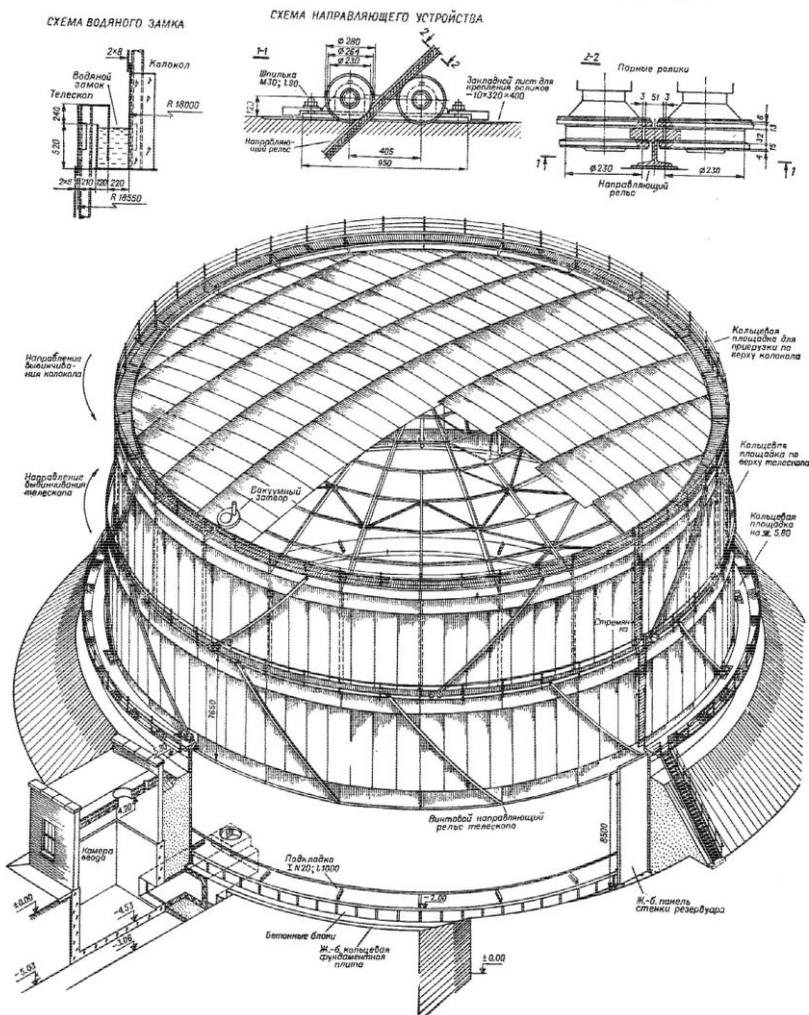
Двухзвенный телескопический газгольдер с винтовыми направляющими
